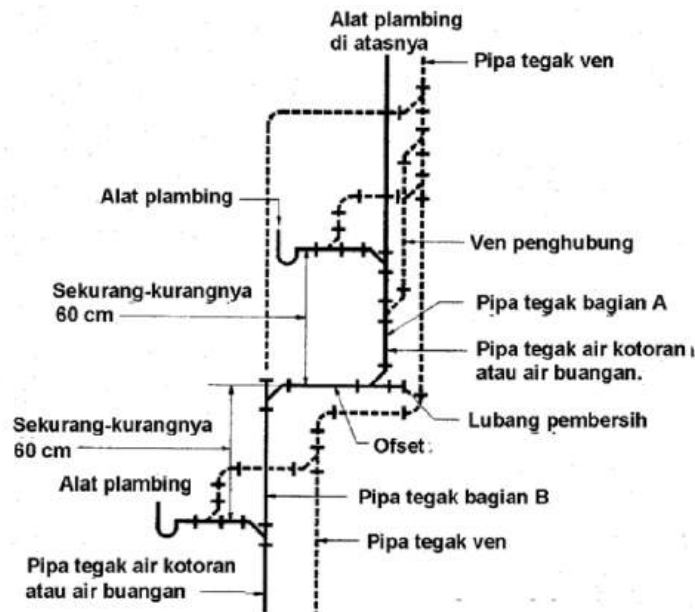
Pipa tegak air limbah untuk bangunan gedung lebih dari 10 lantai
